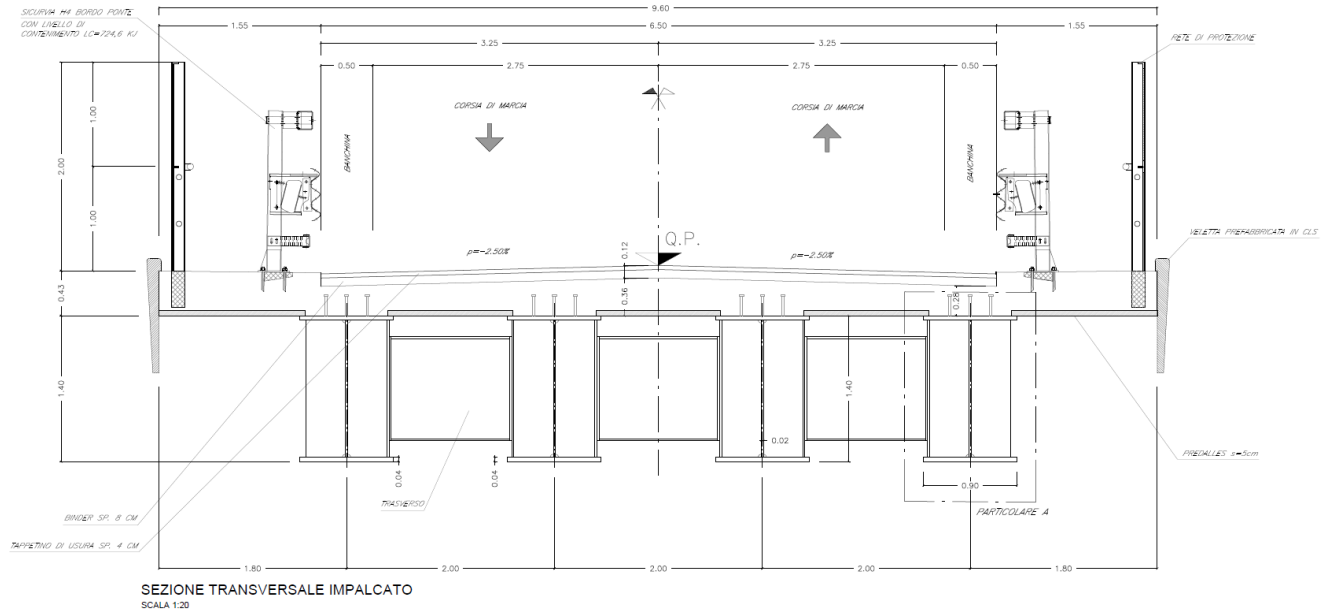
Sezione trasversale impalcato per campata tipo da 30 m e larghezza piattaforma stradale 9.60m.
